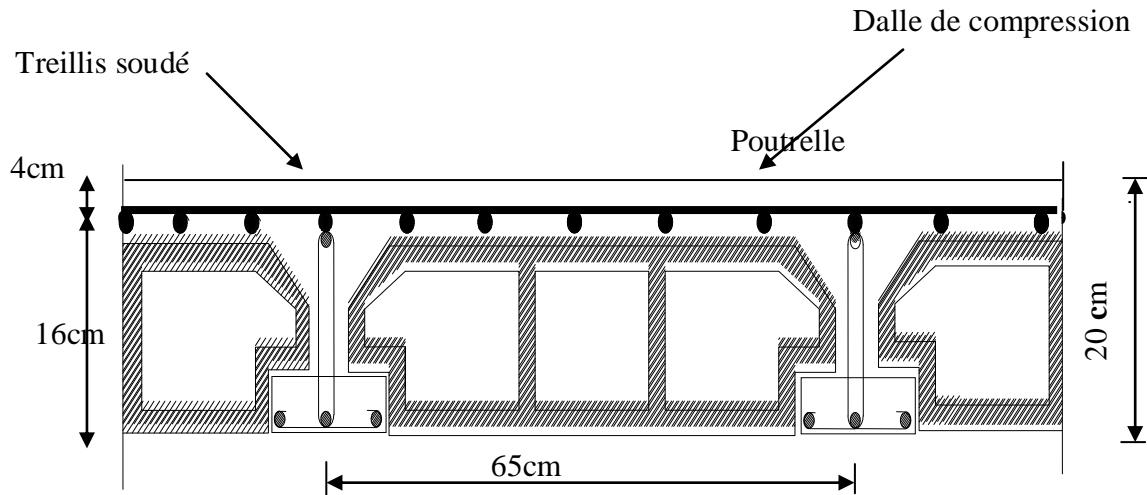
Coupe transversale d'un plancher en corps creux.
